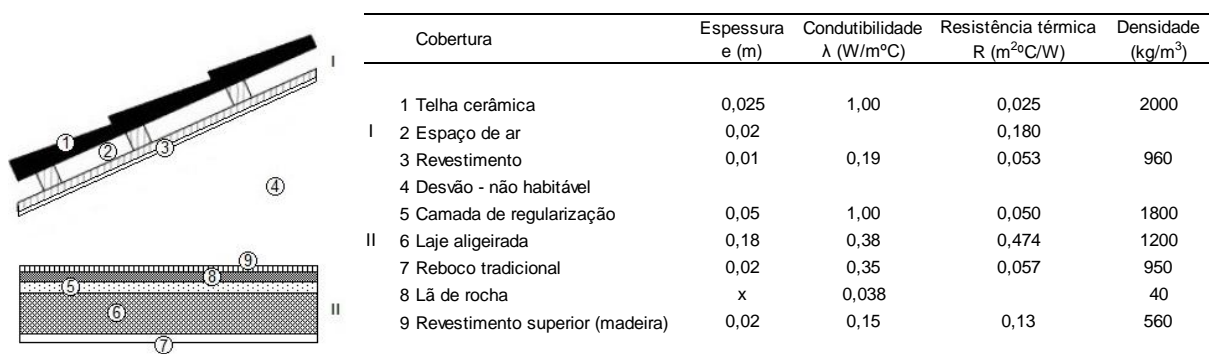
Pormenor e características da tipologia construtiva da cobertura após intervenção de reabilitação.
